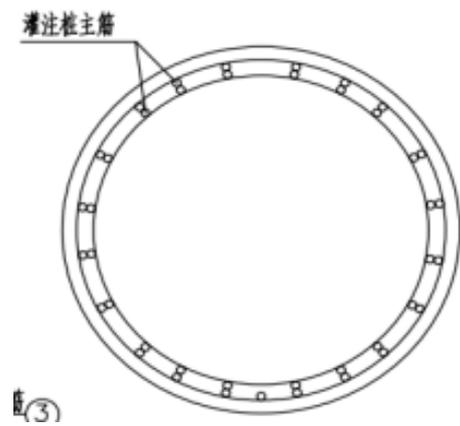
立柱桩钢筋笼88根钢筋并筋大样图
